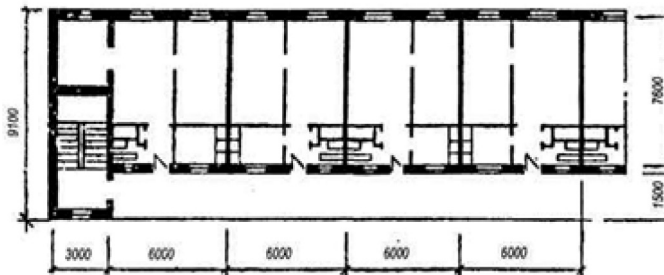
Планувальні схеми житлових будинків:
